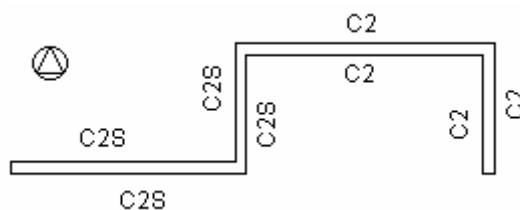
Representação esquemática – Planta da estação de envelhecimento natural.
